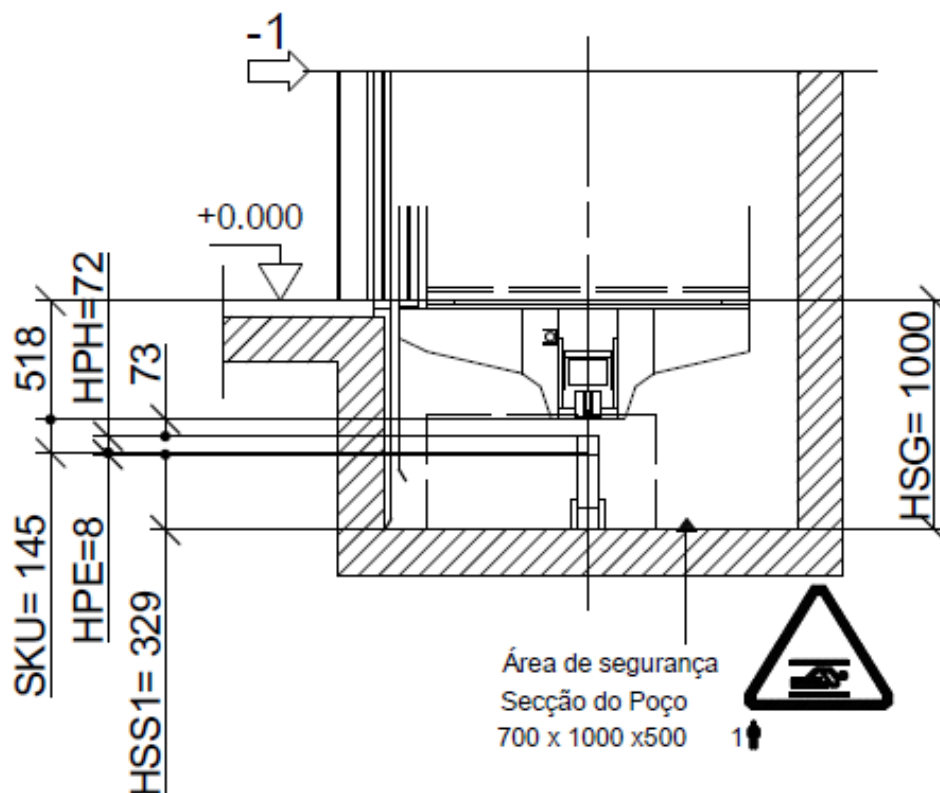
Pormenor do fundo da caixa dos elevadores [Schindler, 2019]
